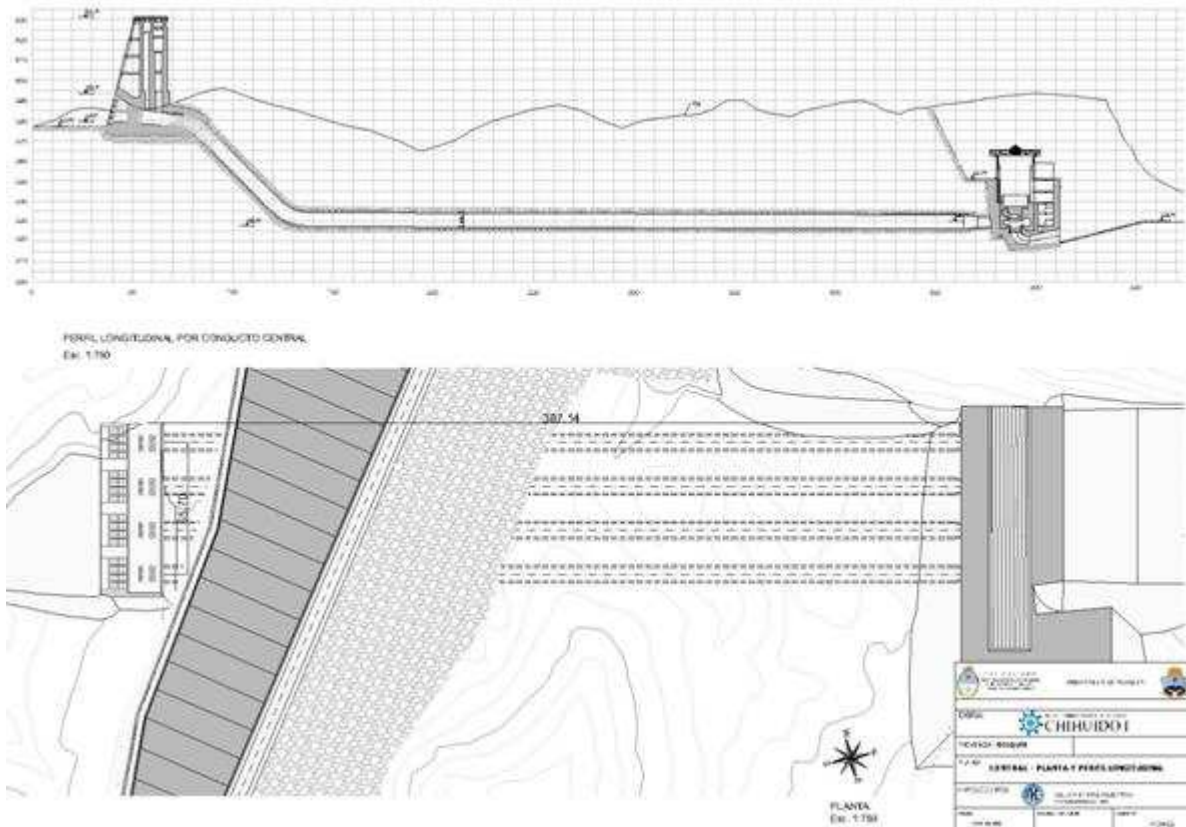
Planimetría y Perfil Longitudinal de la Toma, Conducción y Central
